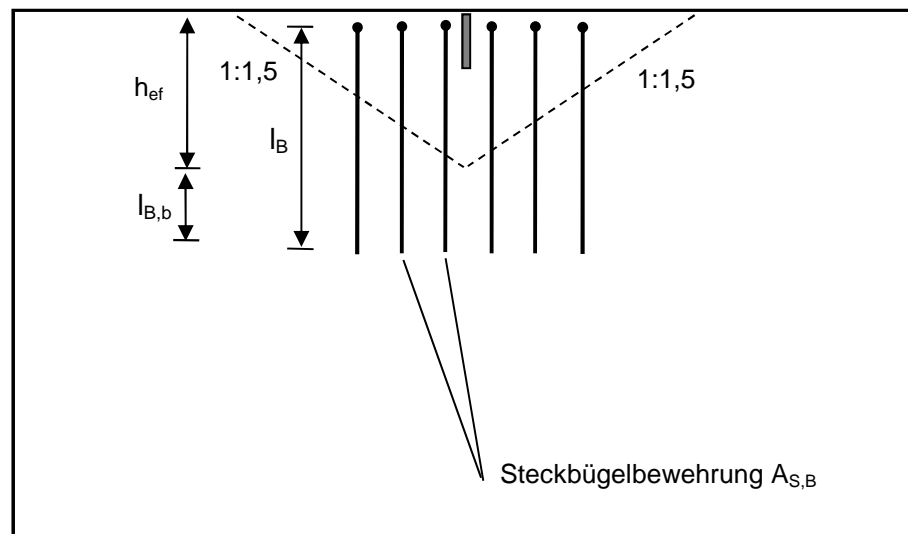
Verankerung der Steckbügelbewehrung unterhalb des Betonausbruchkegels
